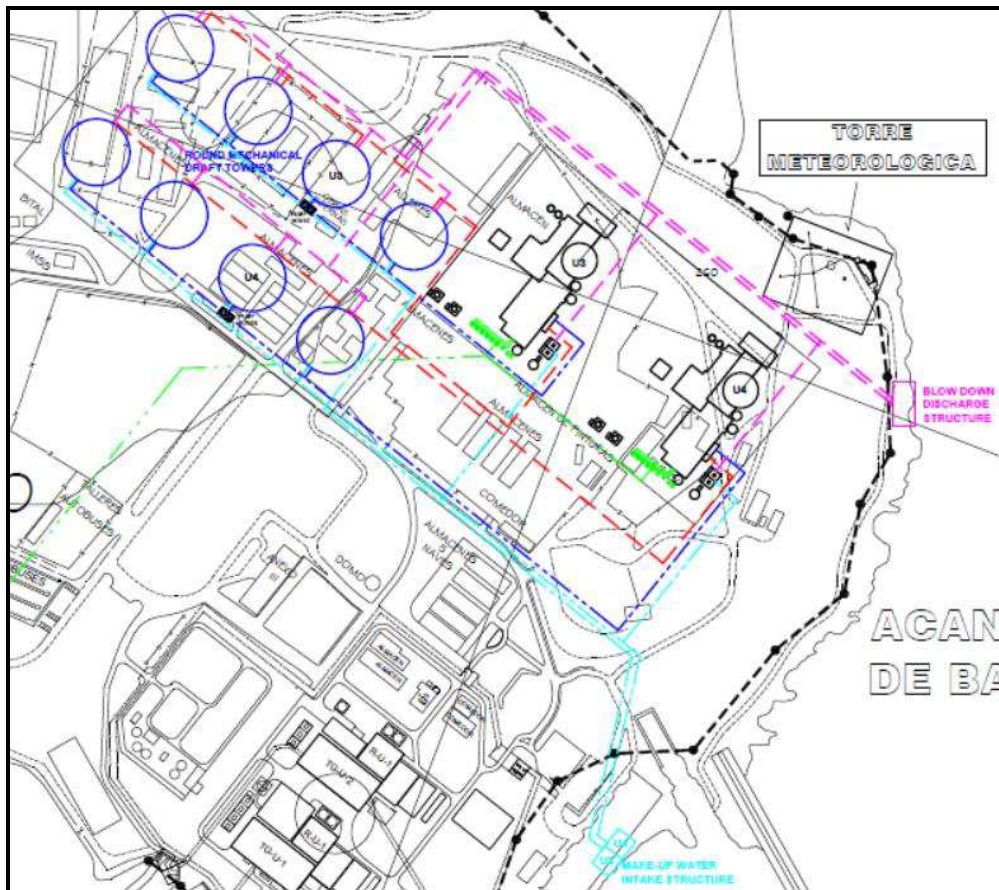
Vista de Planta Sistema Cerrado con Torres de Enfriamiento
